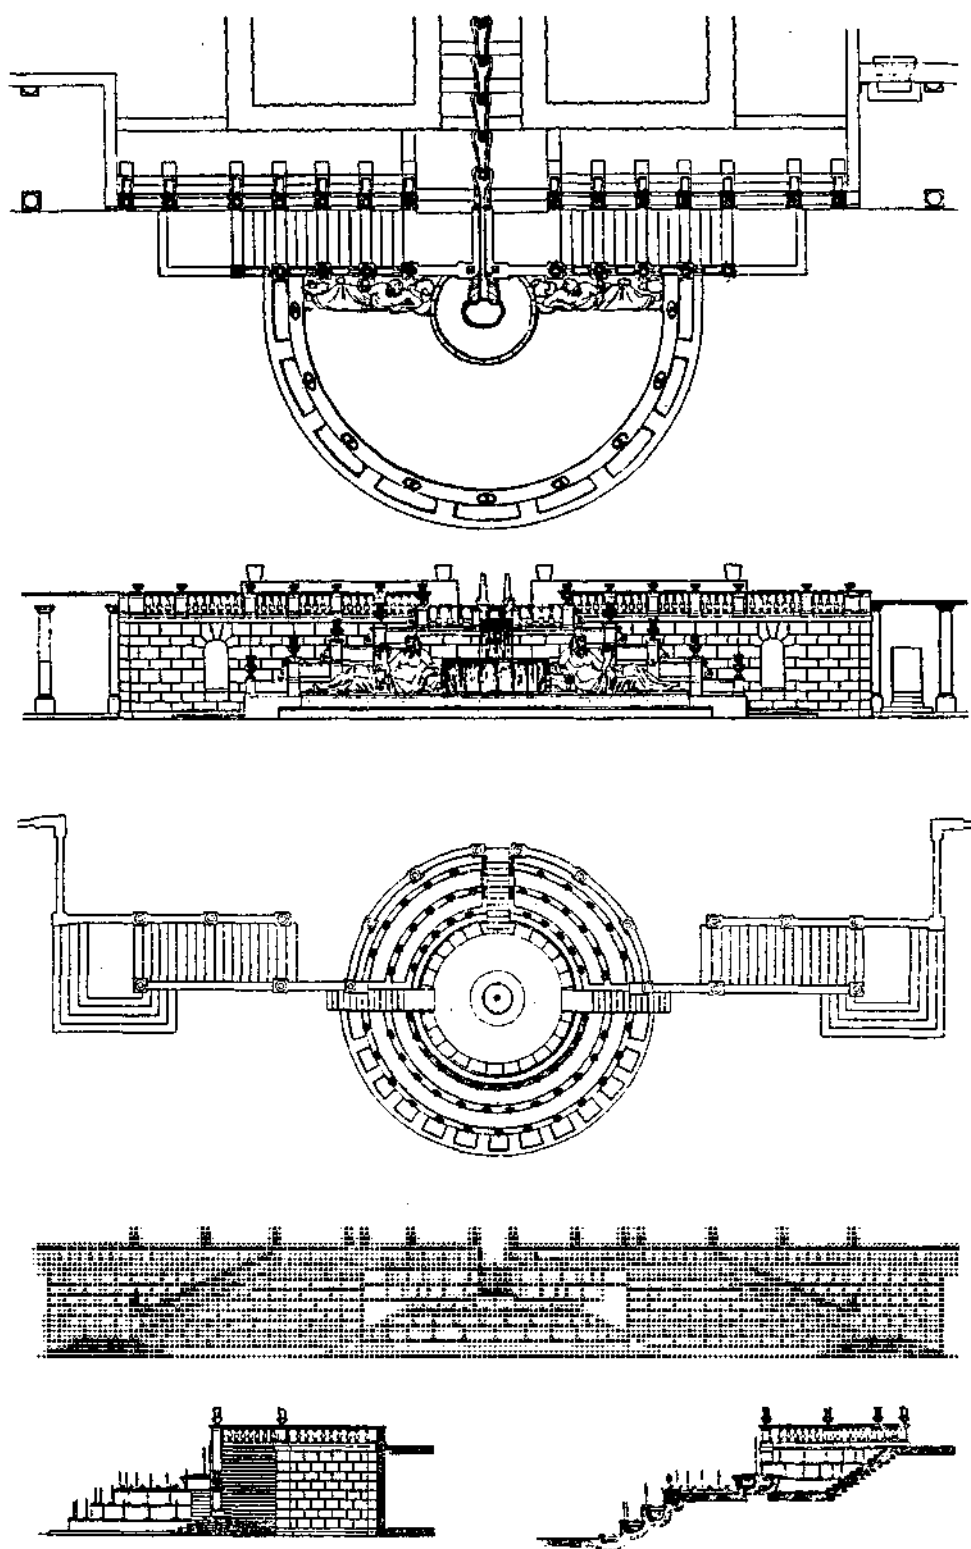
Villa Lante: fuente de los Gigantes; planta y alzado (de Fariello).
